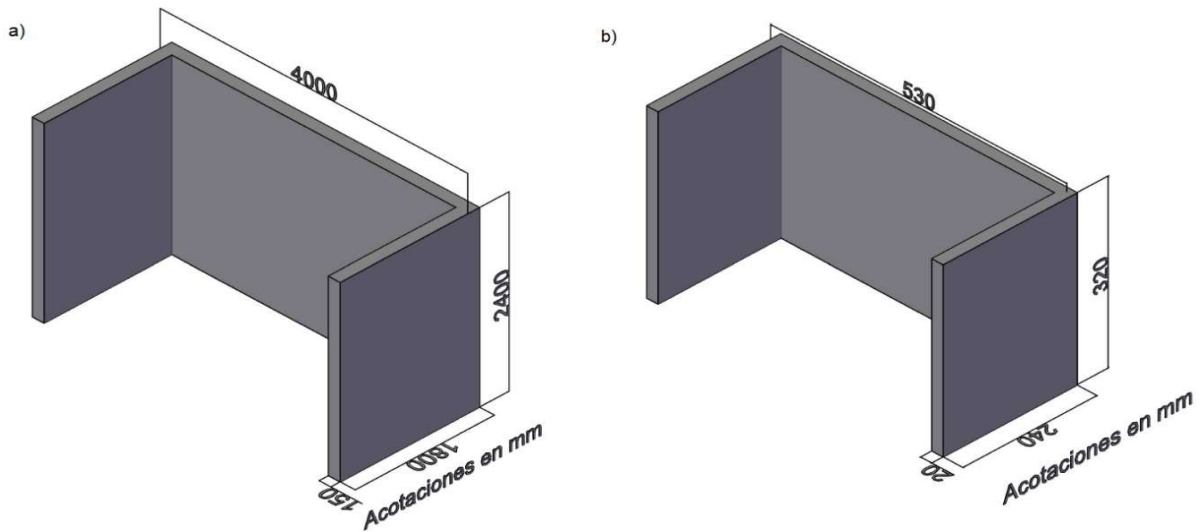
Dimensiones del muro en forma de U: a) dimensiones reales de diseño; b) dimensiones a escala reducida.
